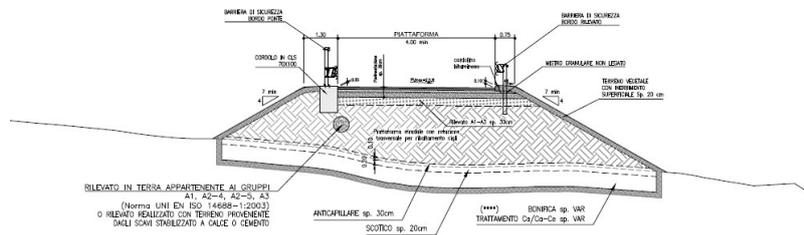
Sezione tipo in rilevato della viabilità di servizio VS18B
